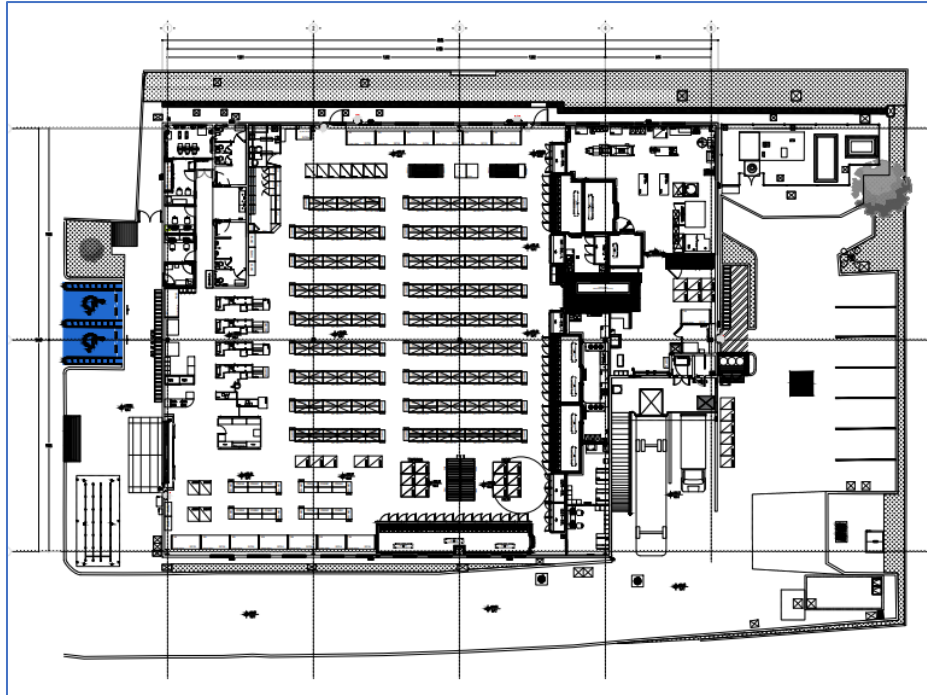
Planta arquitectónica de la tienda de autoservicio².
